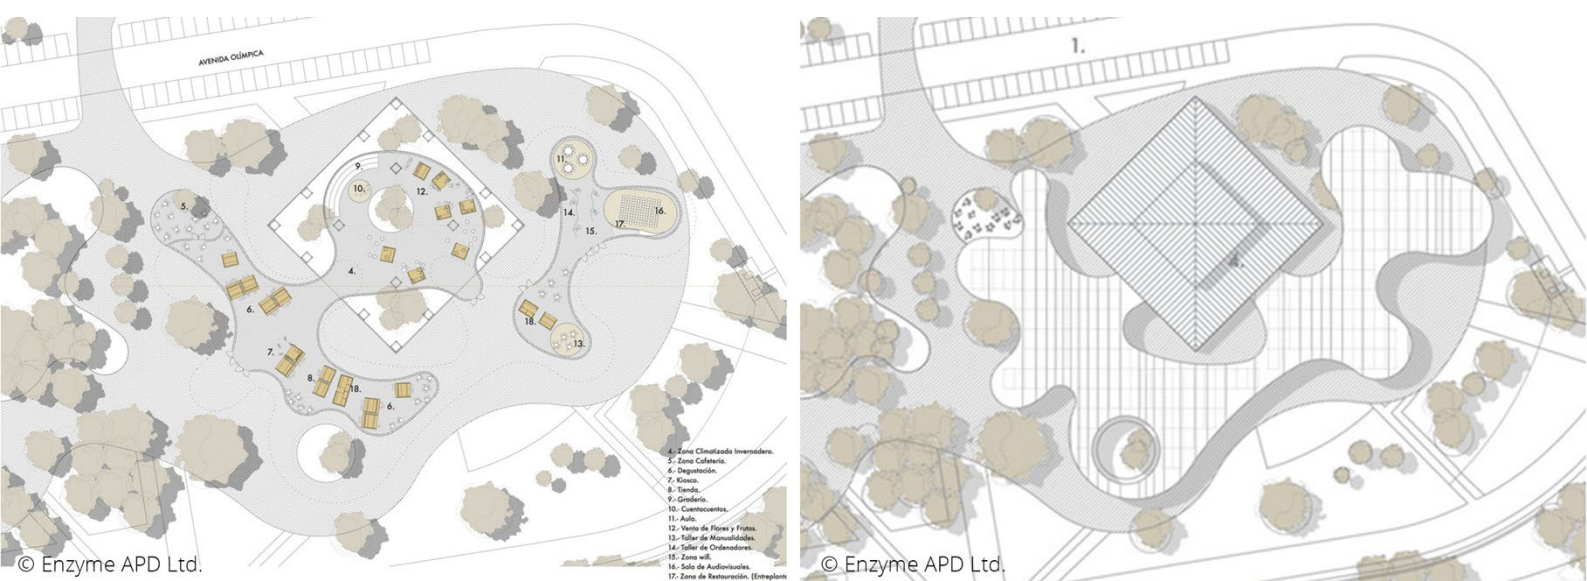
enzyme. APD 社による a) 地上階平面図 b) 屋根伏図
